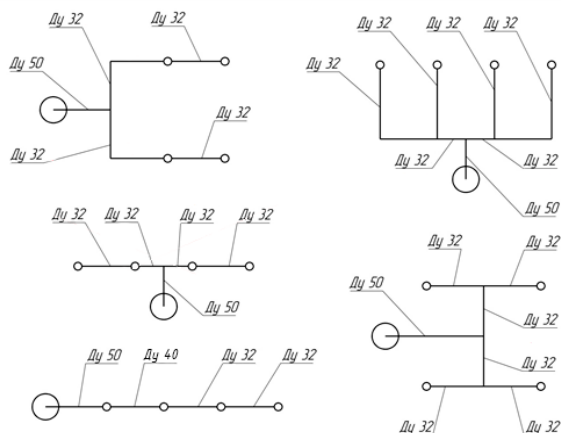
Рекомендуемые схемы проектирования трубопровода в составе МУПТВ-160-Г-ВД с насадками-распылителями «НС-390-С»
